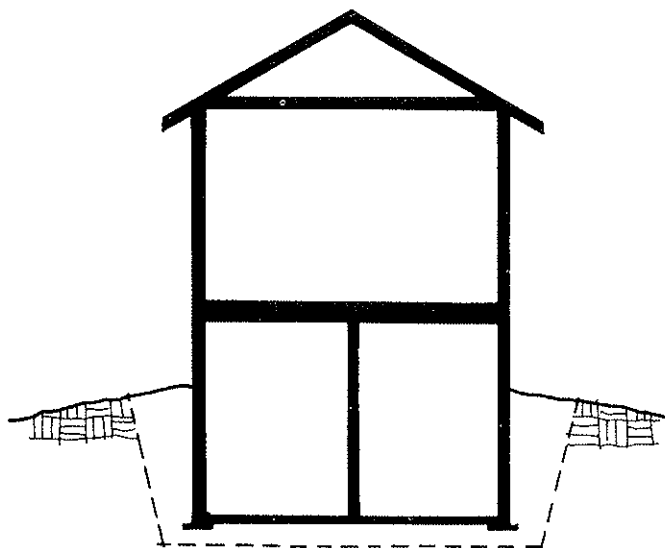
Plancher de sous-sol en dalle de béton ou avec traverse de bois
